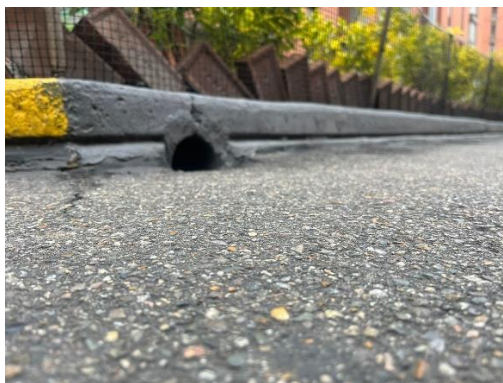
Pavimento Asfáltico, carpeta de rodadura
